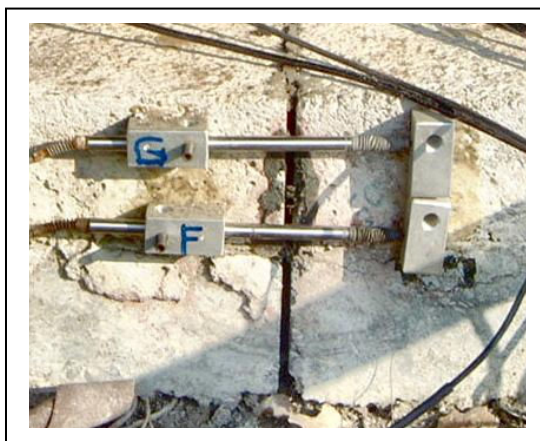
Capteurs LVDT sur la surface latéral de la dalle béton placés pour mesurer le déplacement horizontal des dalles au niveau du joint.
